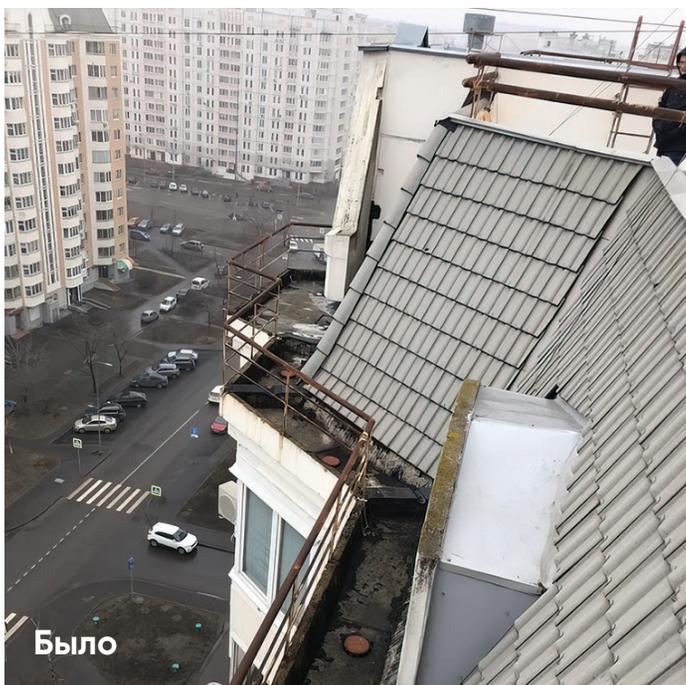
Капитальный ремонт кровли ложных балконов дома. Фото предоставлено советом многоквартирного дома
